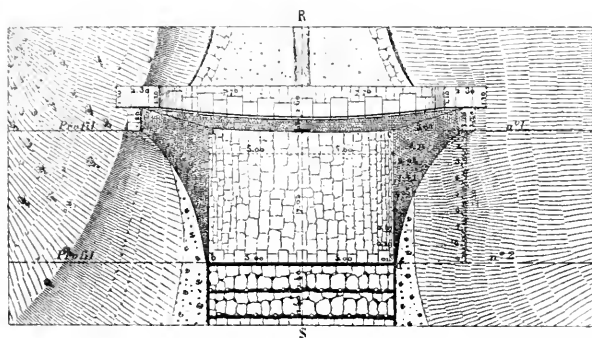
Plan du barrage n° 3, du radier, des murs de revêtement à surface gauche et d'une portion de l'enrochement.
